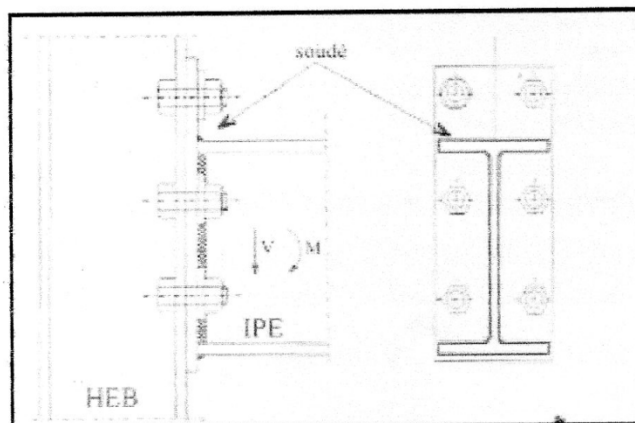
Assemblage boulonnée d'une poutre IPE sur poteau HEB
